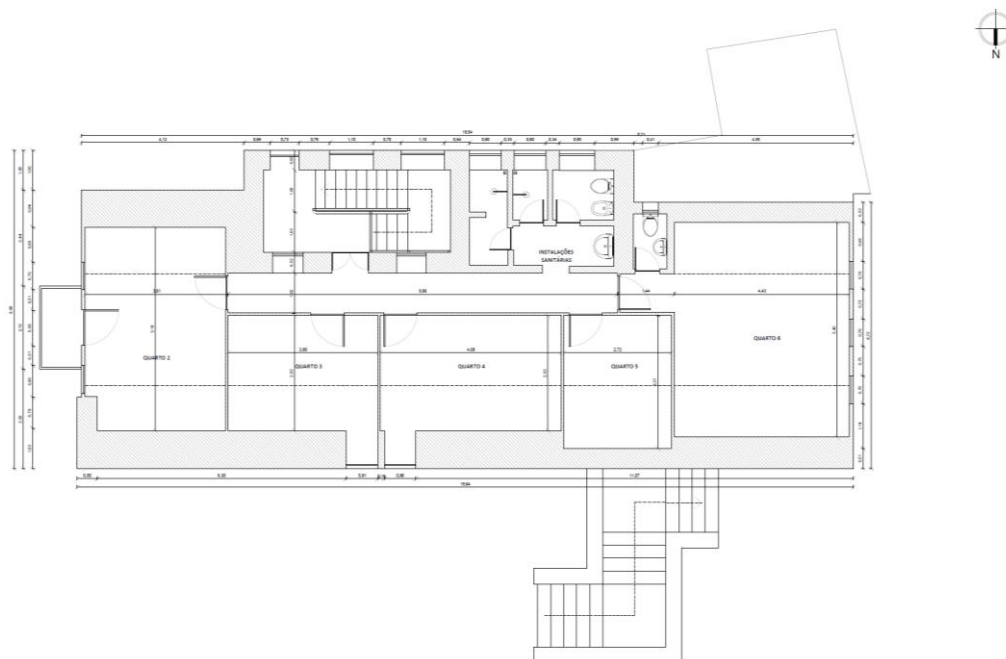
Planta de Levantamento Piso 1, Casa das Queimadas.
